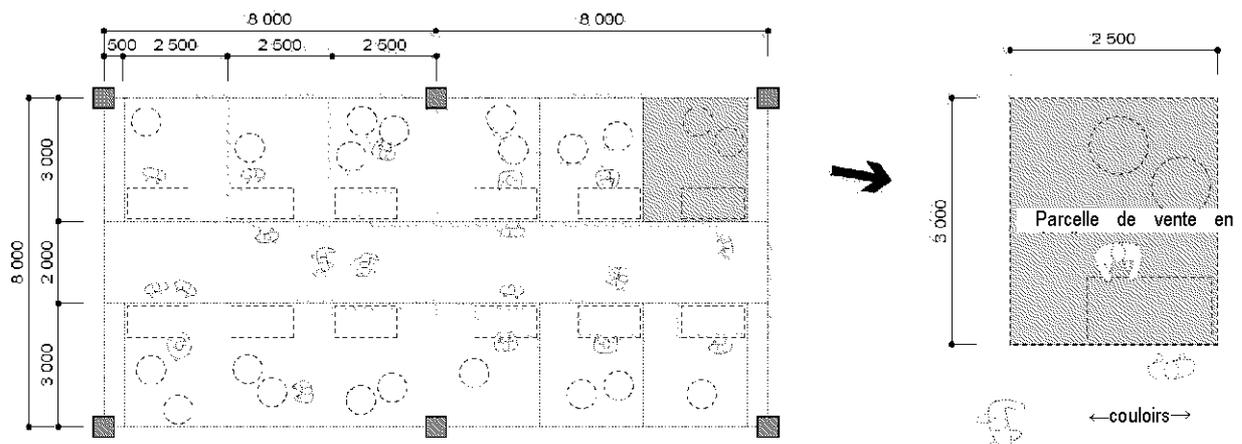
(15) Plan de la halle de vente au détail et plan d'arrangement de parcelles de vente au détail
